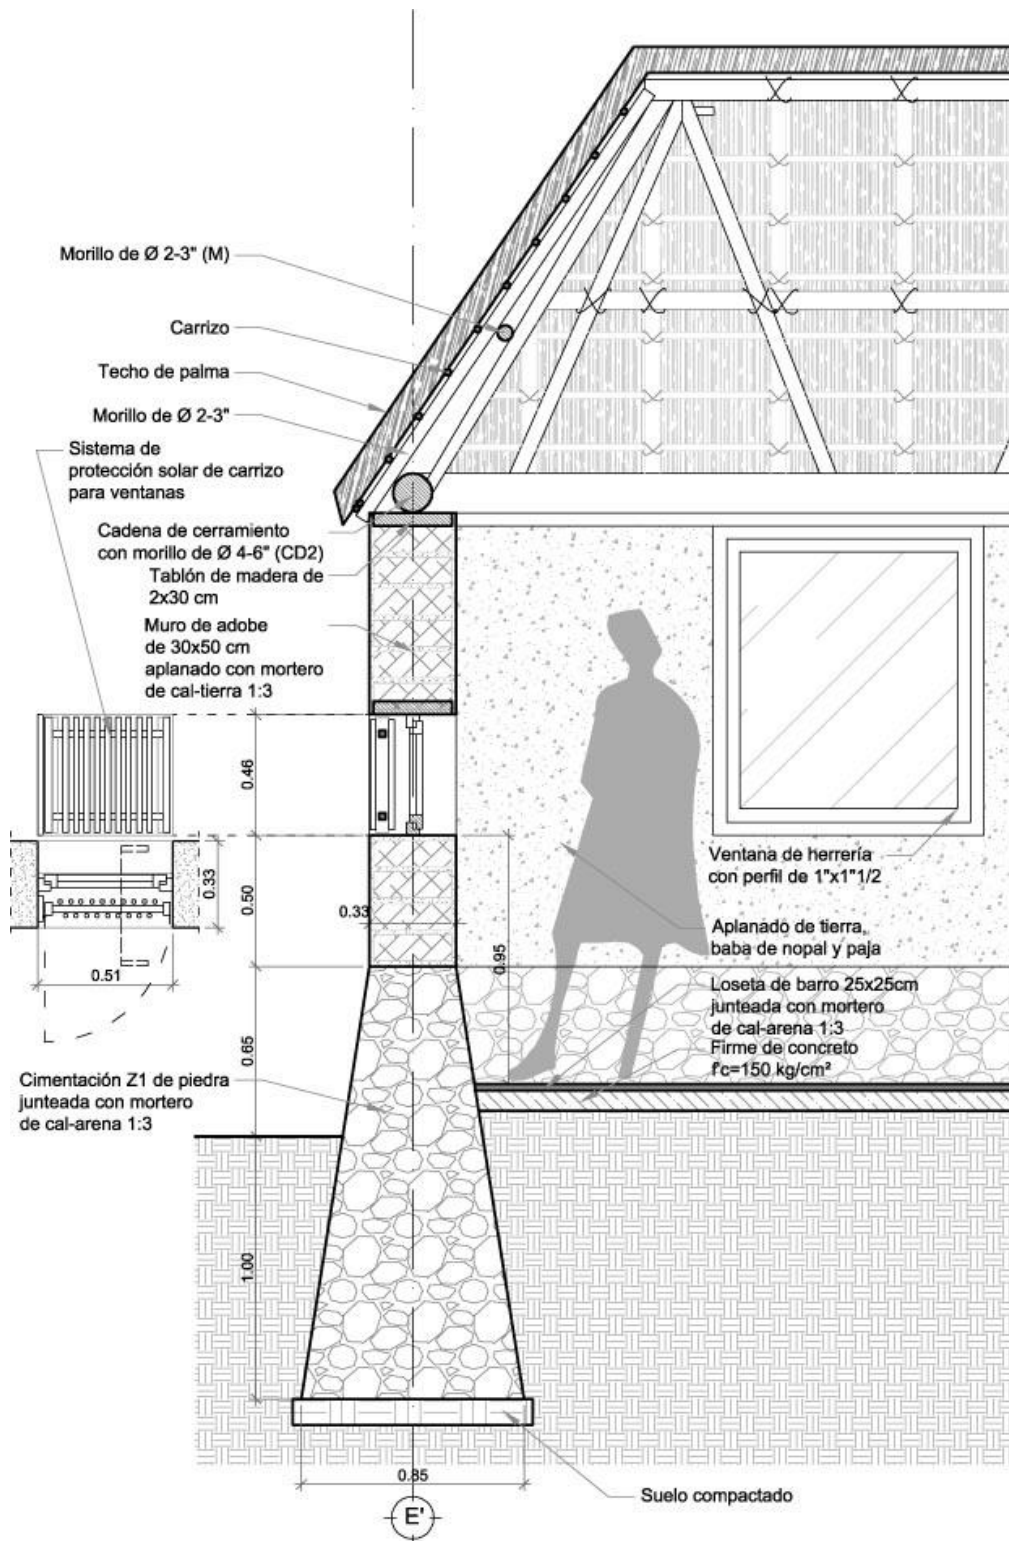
Plano 09; detalles constructivos de los muros de adobe.
